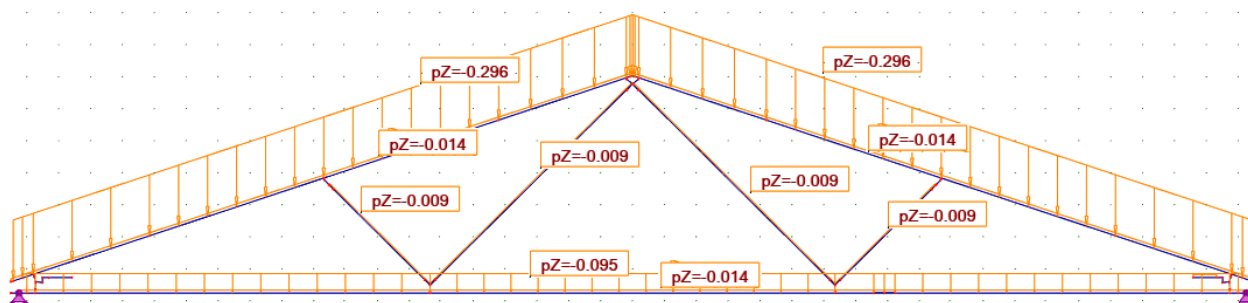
Carregamento permanente aplicado a estrutura (N/mm)
